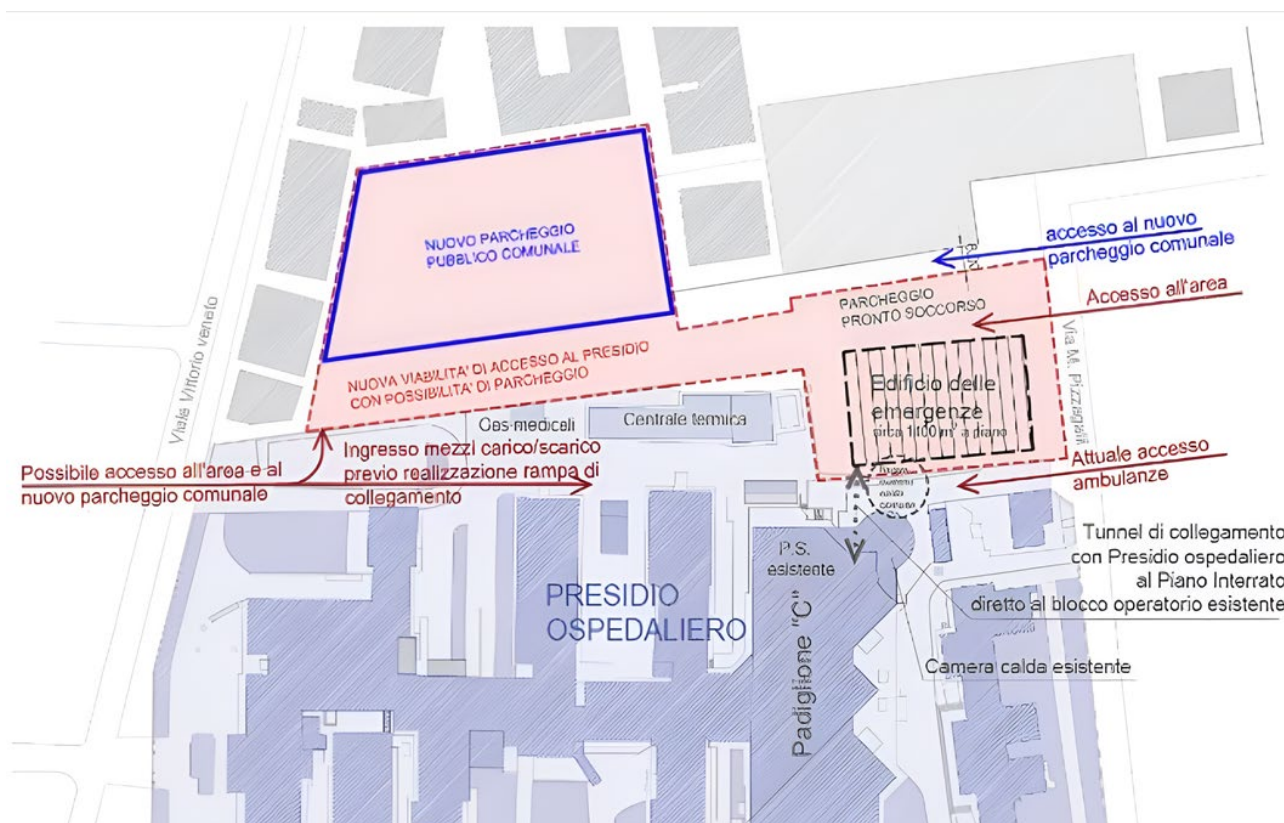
Planimetria dello stato di fatto con identificazione dell'area di progetto e delle connessioni di progetto
